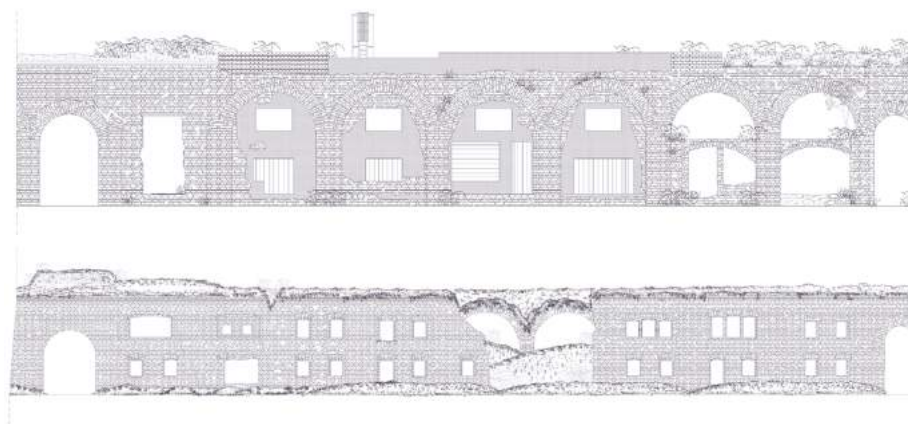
Schadenskartierung, Fassade des Nord- und Nordwestkavaliers
